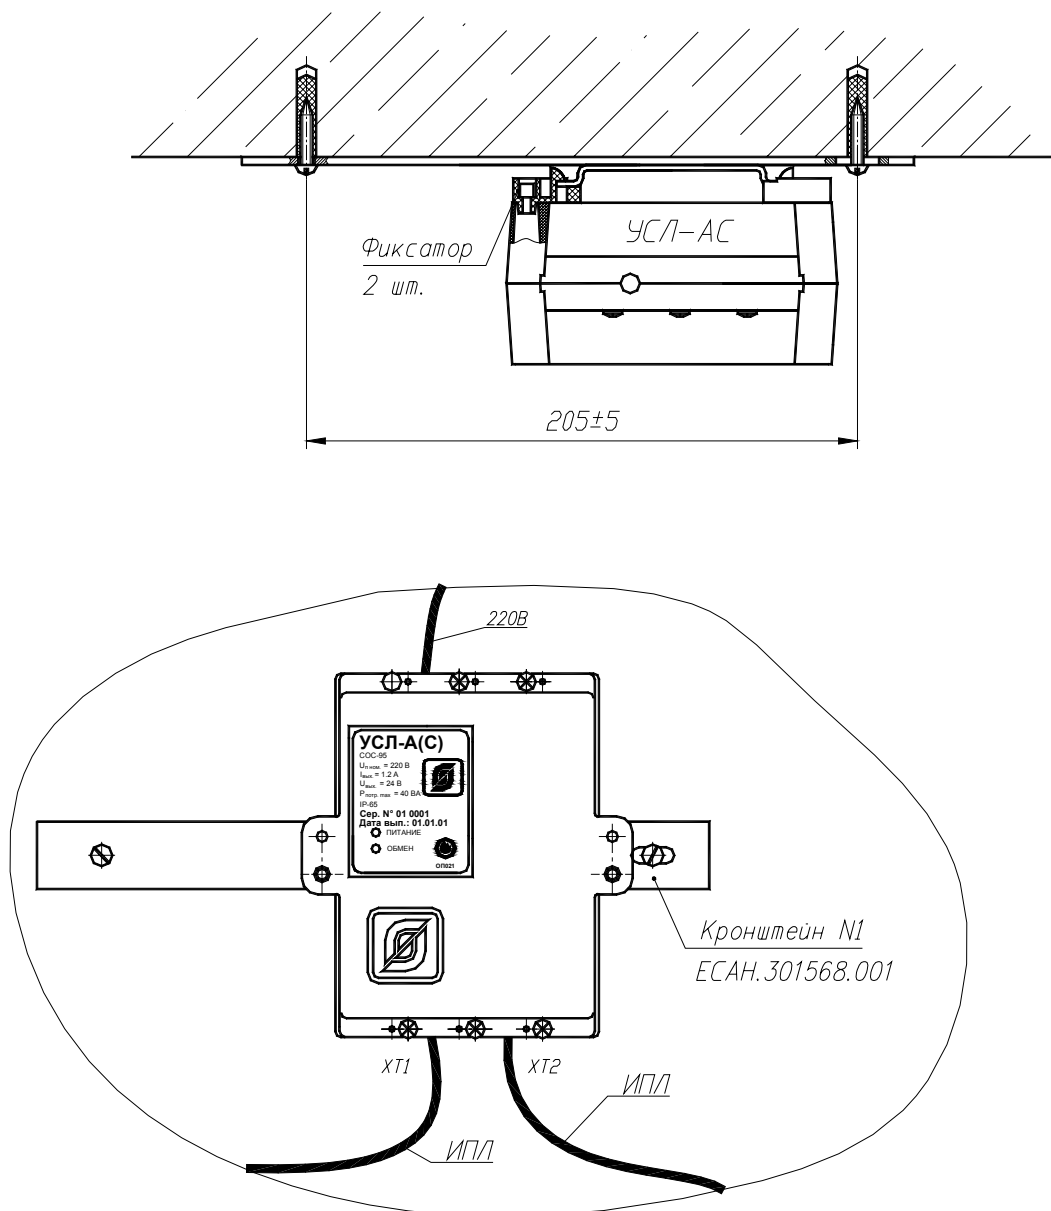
Вариант крепления УСЛ-АС на кронштейне №1
